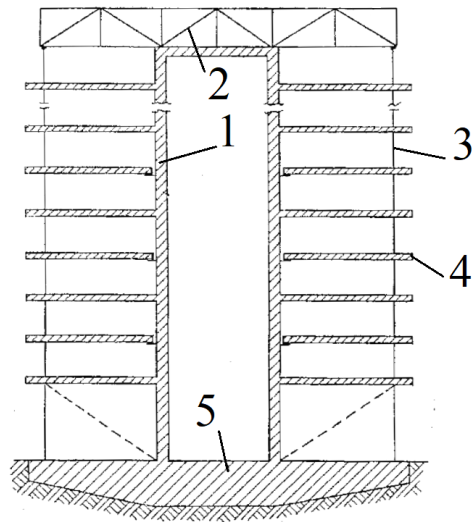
Подвесное сейсмостойкое здание: 1 – ядро жёсткости; 2 – пространственная консольная ферма; 3 – подвеска; 4 – междуэтажные перекрытия; 5 – фундамент
